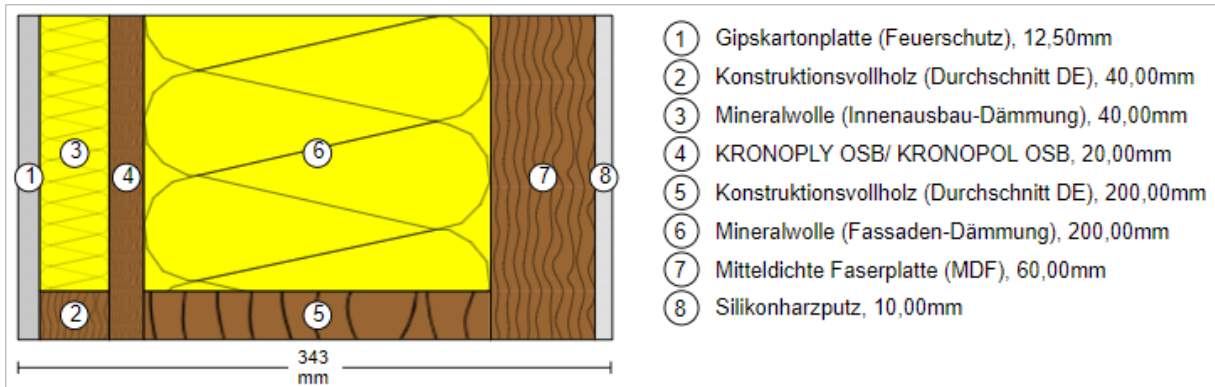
Schemadetail (innen = linke Seite) der Außenwand mit Konstruktionsaufbau.
